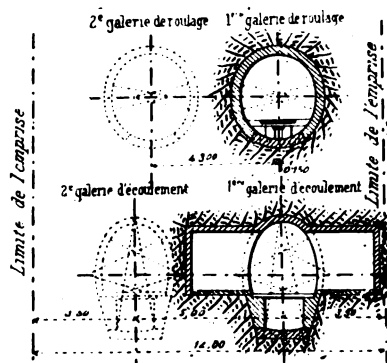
Coupe d'ensemble du projet complet de galeries.
